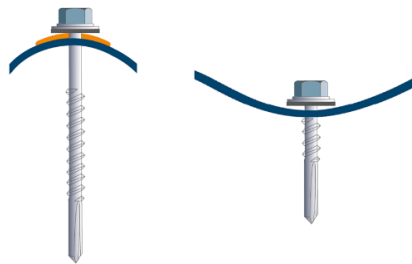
Fixation en sommet d'ondulation (à gauche) et fixation en fond de vallée (à droite).
